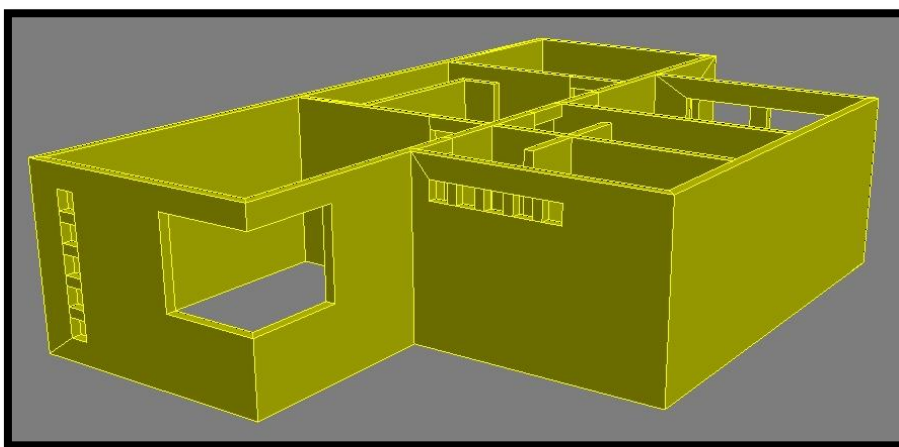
Estructuras Rígidas Tipo Cajón (Fuente: www.murolpac.com)
